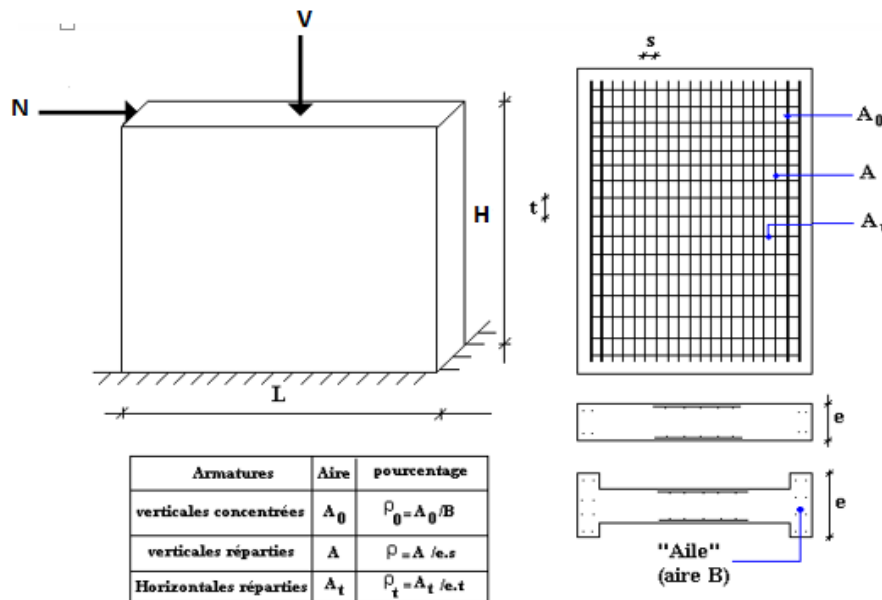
Schéma d'un voile plein et disposition du ferrailage.
